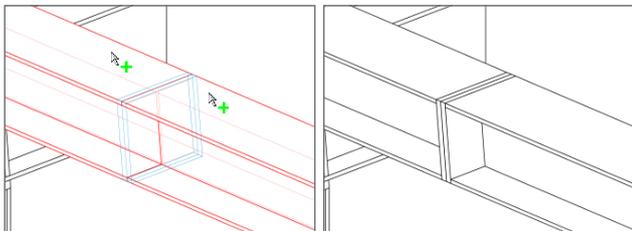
Erzeugung Stirnplattenstoß markieren der Bauteile
